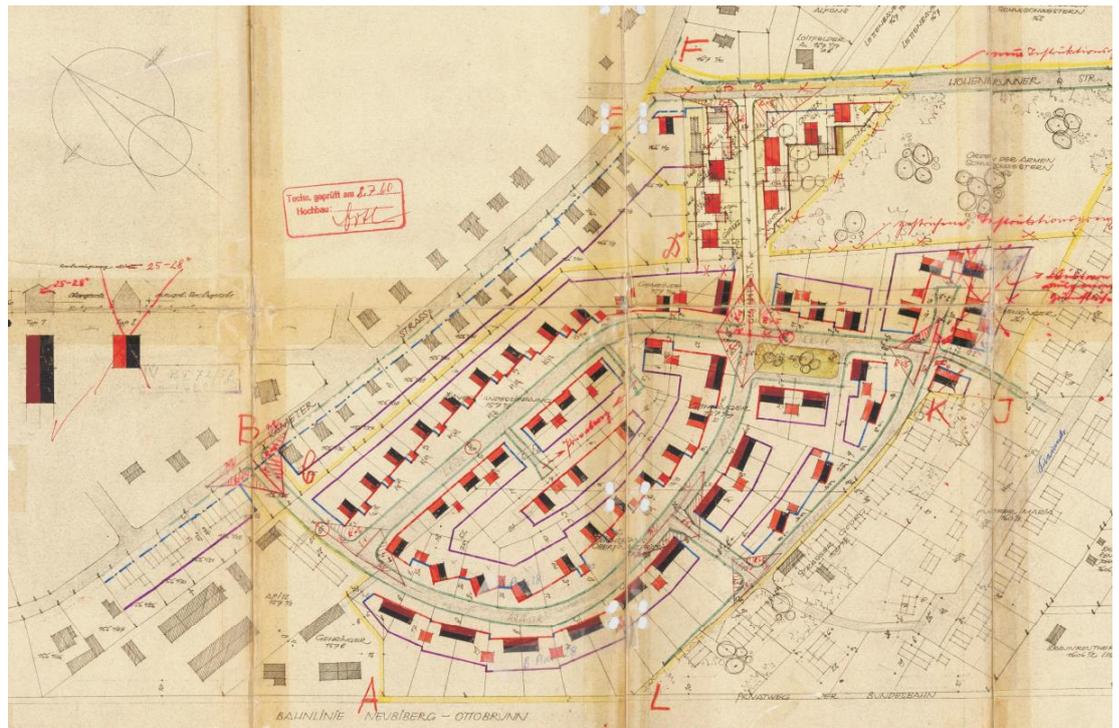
Ausschnitt aus dem einfachen Bebauungsplan Nr. 13 „Aufteilungs-, Baulinien- und Bauungsplan für das Gebiet zwischen der Kameter-, Putzbrunner, Hohenbrunner Straße und der Bahnlinie Neubiberg/Ottobrunn“ in Kraft getreten am 30.11.1960, ohne Maßstab
